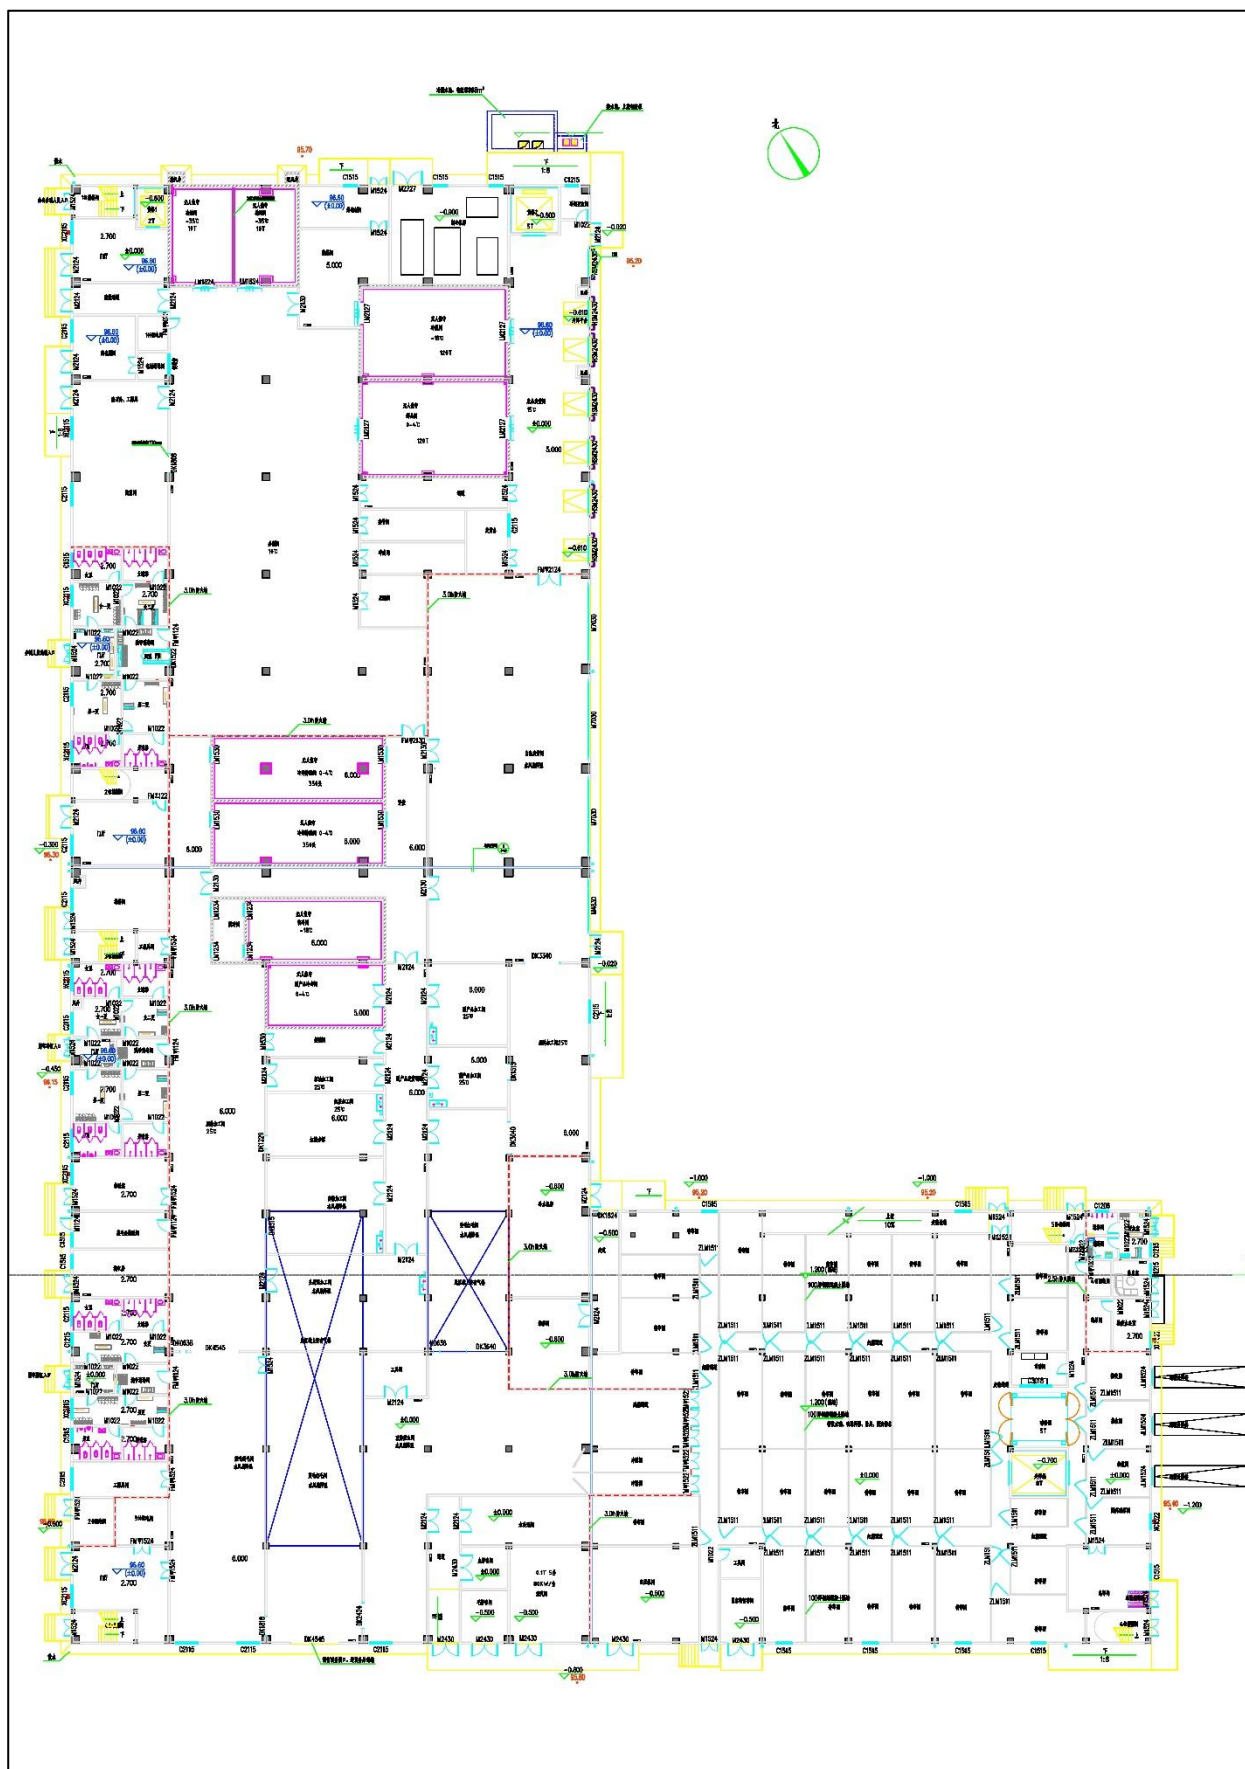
猪屠宰分割车间平面布置图（一层）
